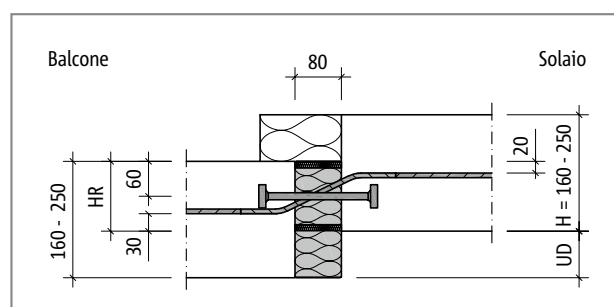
Schöck Isokorb® T tipo QL-UD: sezione dell'elemento
